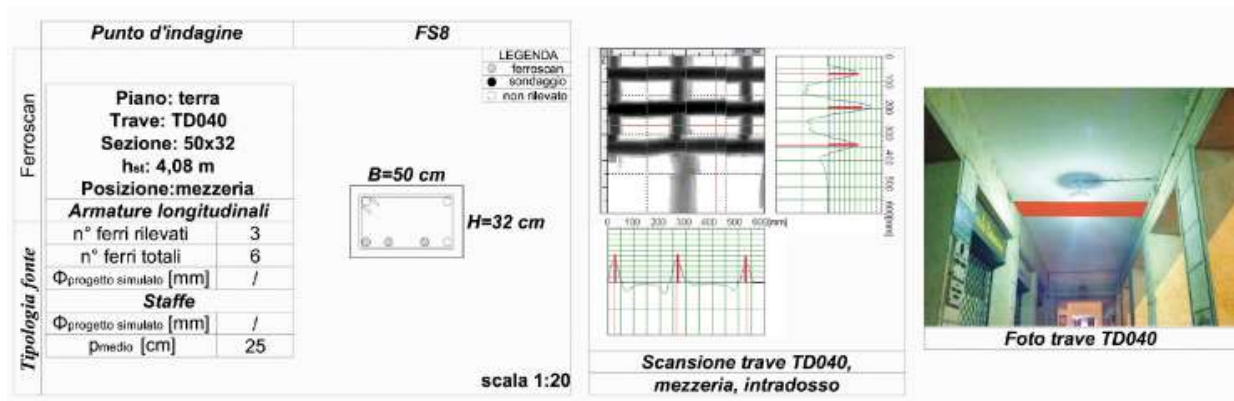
Sondaggio sulla trave TD040 al piano terra.
